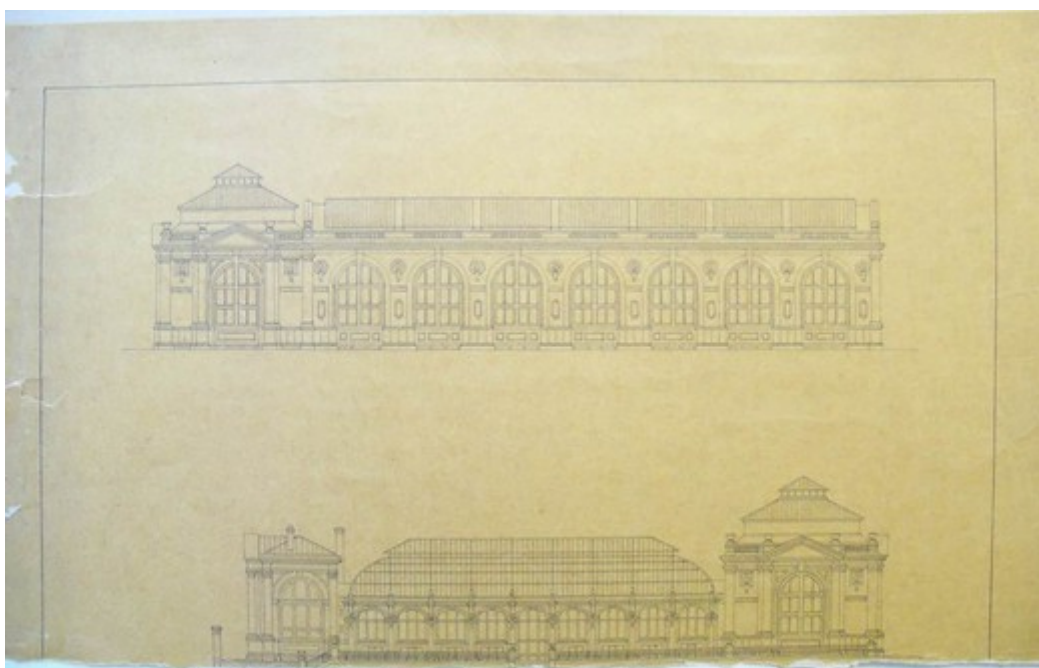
Charles Gondoin, [Elévations de la façade sud de l'orangerie prolongée et de la façade ouest de l'extension], minute, s.d. [février 1884] (Sénat/DAPJ, n°244, cote provisoire).
